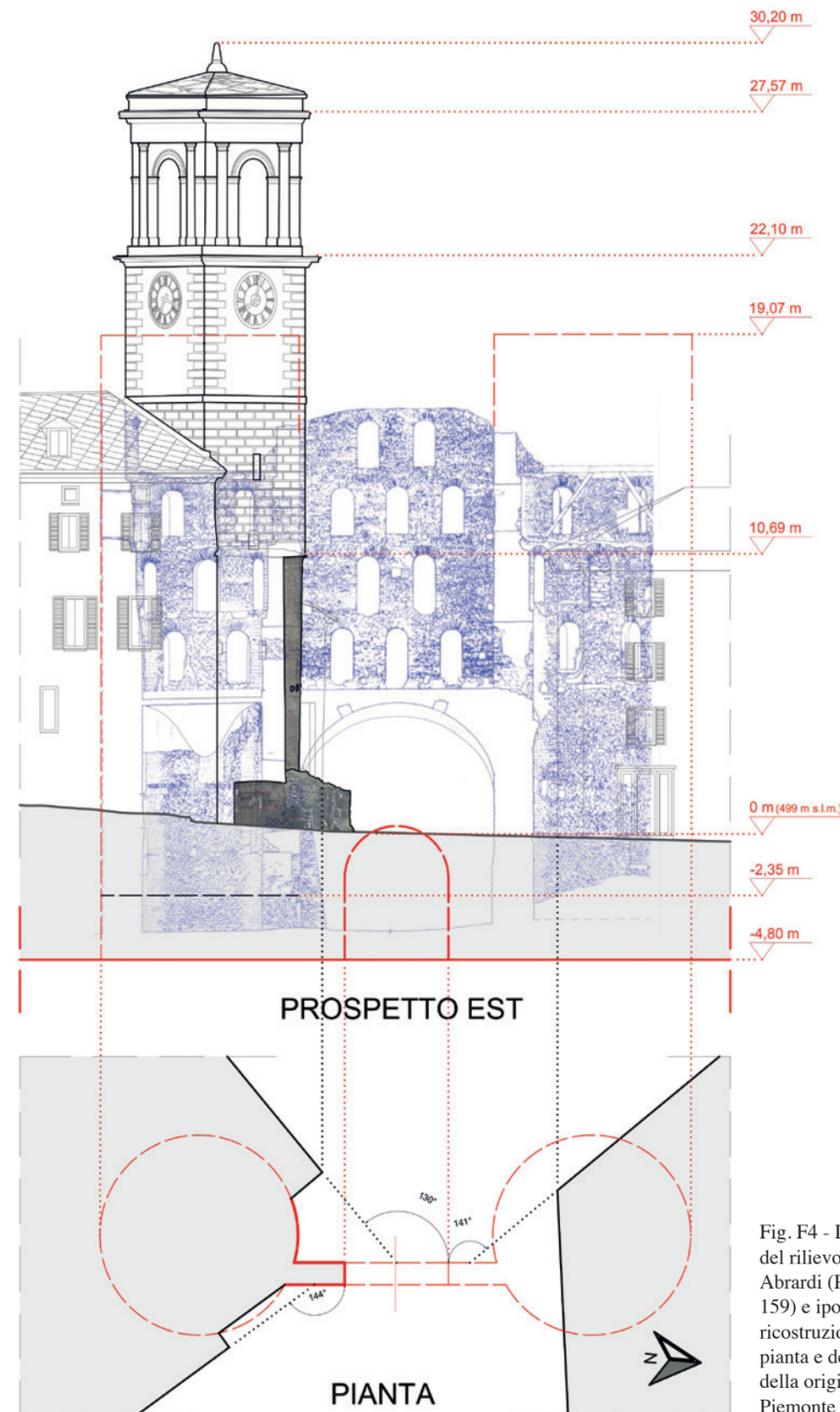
Inserimento del rilievo di G. Abrardi (P.P., pag 159) e ipotesi di ricostruzione della pianta e del prospetto della originaria Porta Piemonte (in rosso).
